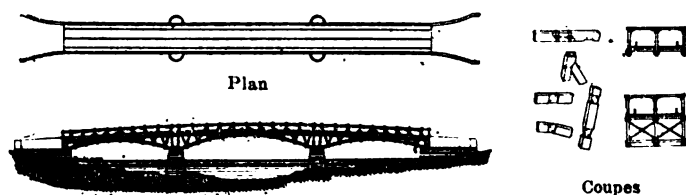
et 8. — *Permanent Bridge* sur le Schuylkill.
